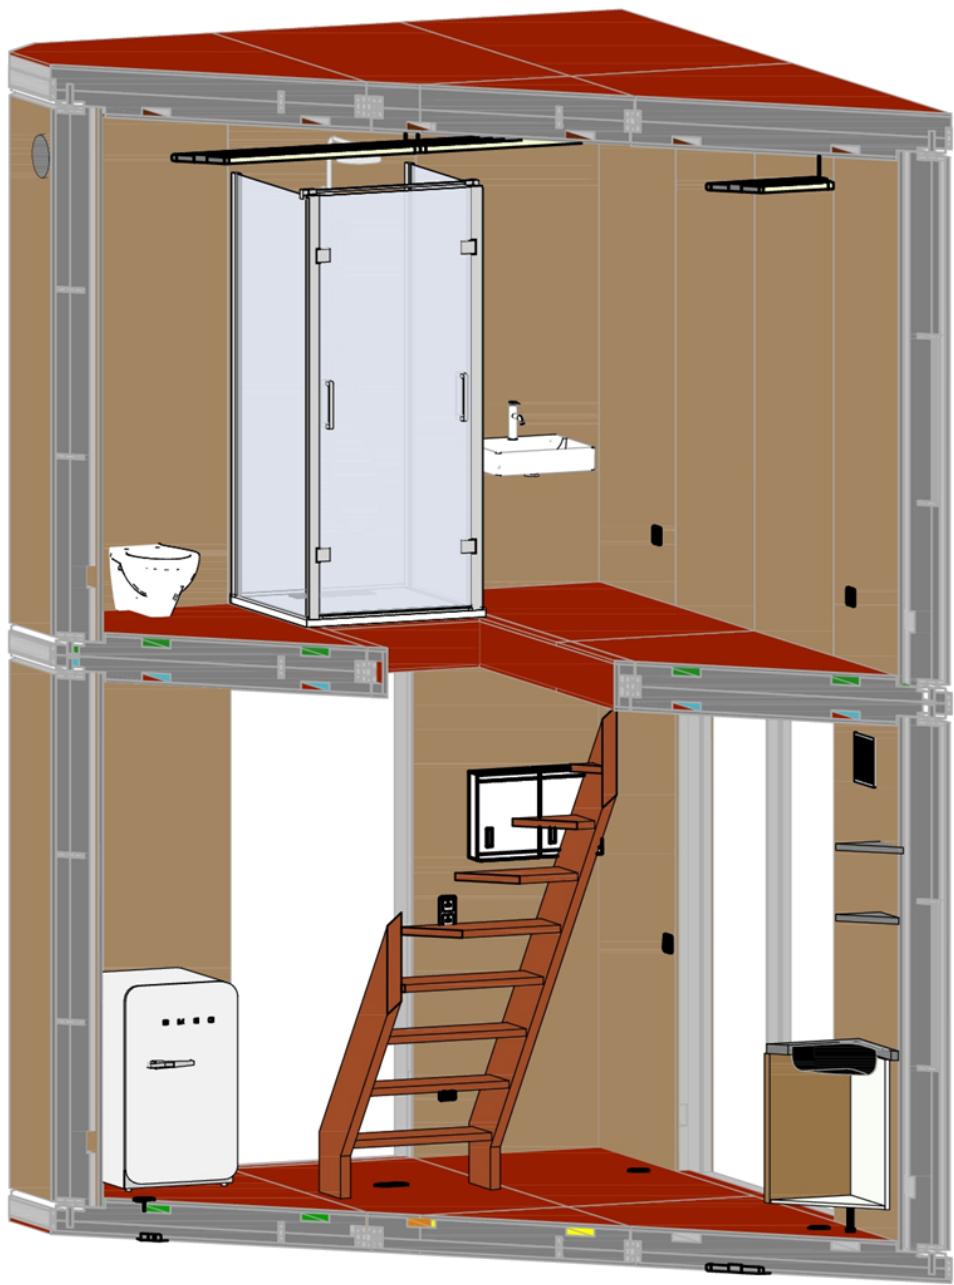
Axonometria Seccionalda Construção Piloto – Metodologia BIM
